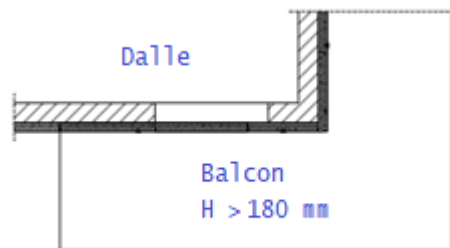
Balcon en béton armé d'angle extérieur [10].
